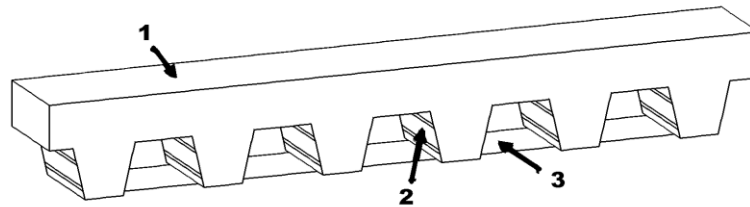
Конструктивное решение сталежелезобетонной плиты с внешним армированием профилированным настилом и затяжкой поперек гофры
